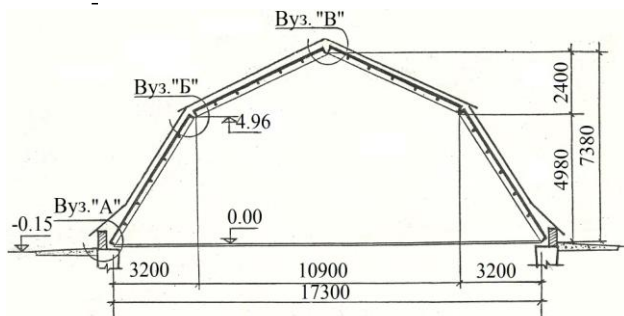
Поперечник безкаркасної сільськогосподарської будівлі універсального призначення
